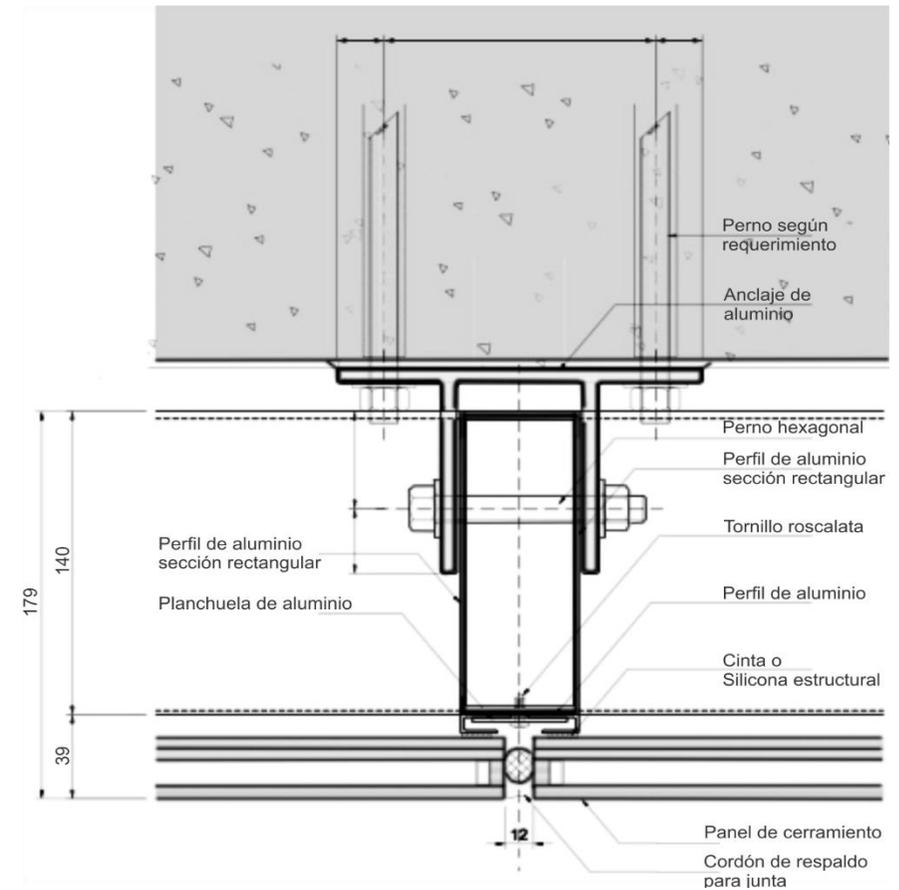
Corte horizontal de una fachada de piel de vidrio
